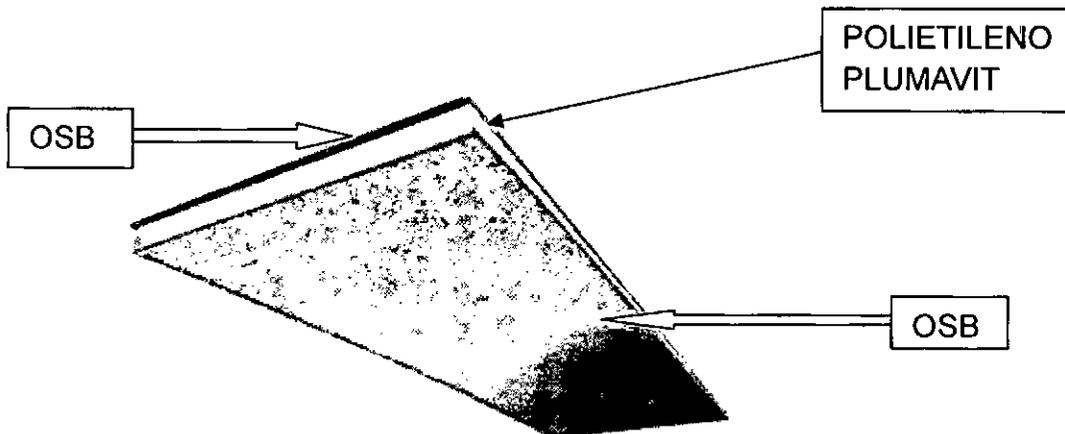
EXTRACTO, <http://www.panelesmecar.com/es/paneles-sandwich-madera.php>
